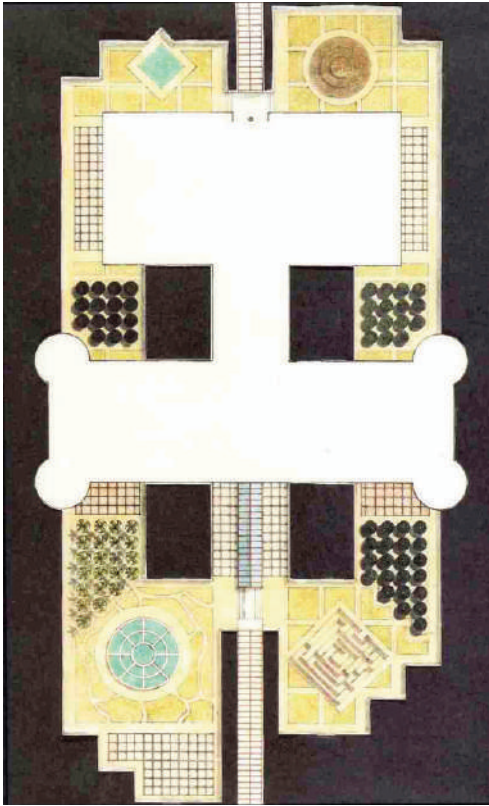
Il Nuovo Palazzo delle Finanze a Palermo: ipotesi per la pianta delle coperture (A. Sposito, 1987).
